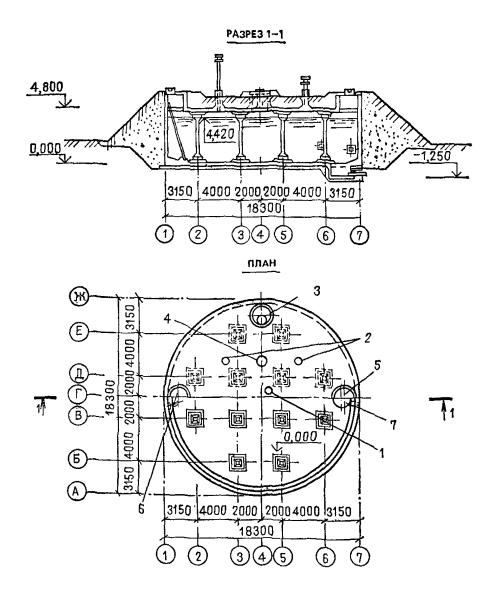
Резервуар для воды вместимостью 1000 м³ цилиндрический из монолитного железобетона для строительства в районах сейсмичностью 8 и 9 баллов. Типовой проект 901-4-52c (к ценам № 362, 363)
